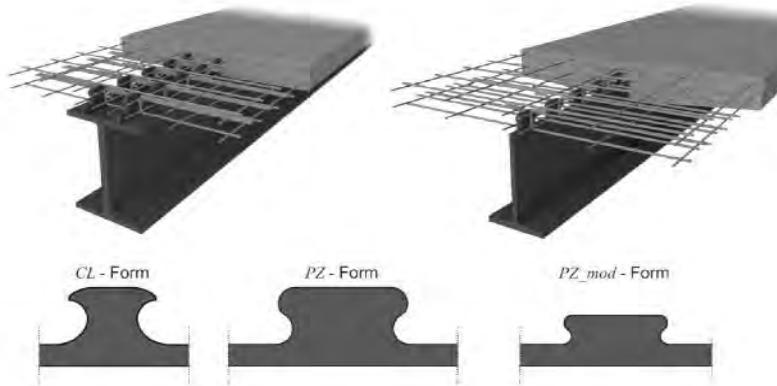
Применение объединения бетона и стали с (сверху слева) или без (сверху справа) верхнего фланца и исследования в работе геометрии полосы (снизу) [10]
